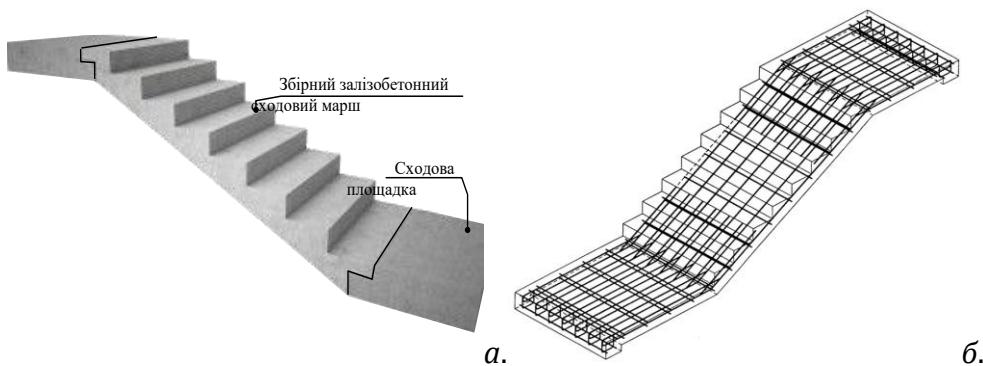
Конструкція збірного залізобетонного сходового маршу (а) та схема його армування (б).
